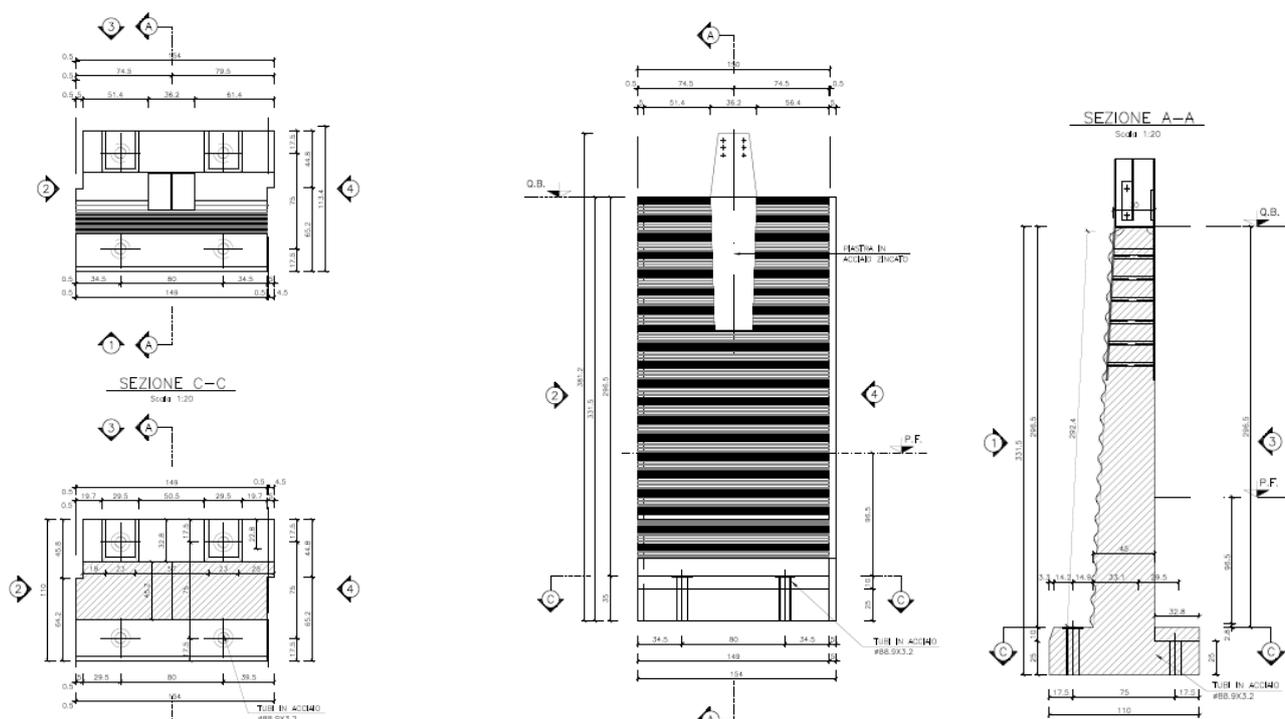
Pianta a livello fondazioni, prospetto e sezione laterale del modulo BM110
